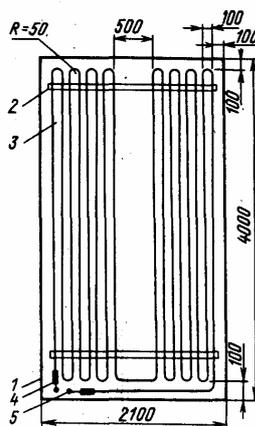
Схема укладки нагревательного провода для обогрева почвы:
